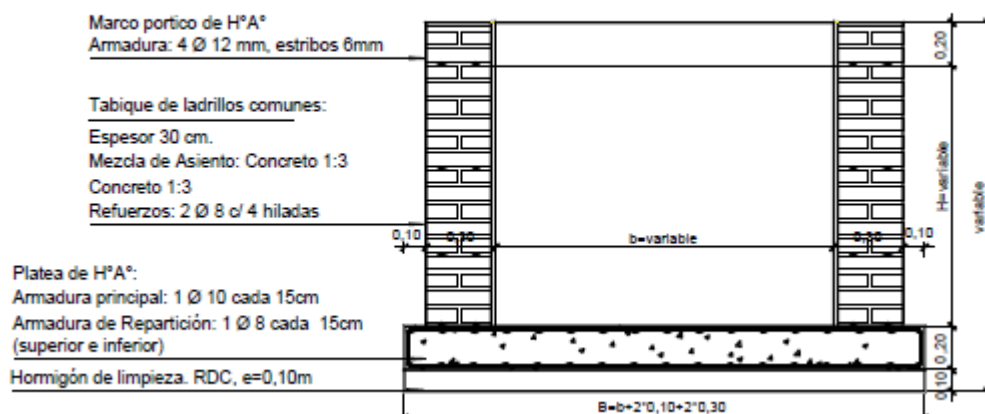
Corte transversal canal revestido de mampostería (Fuente: elaboración propia, 2025)
